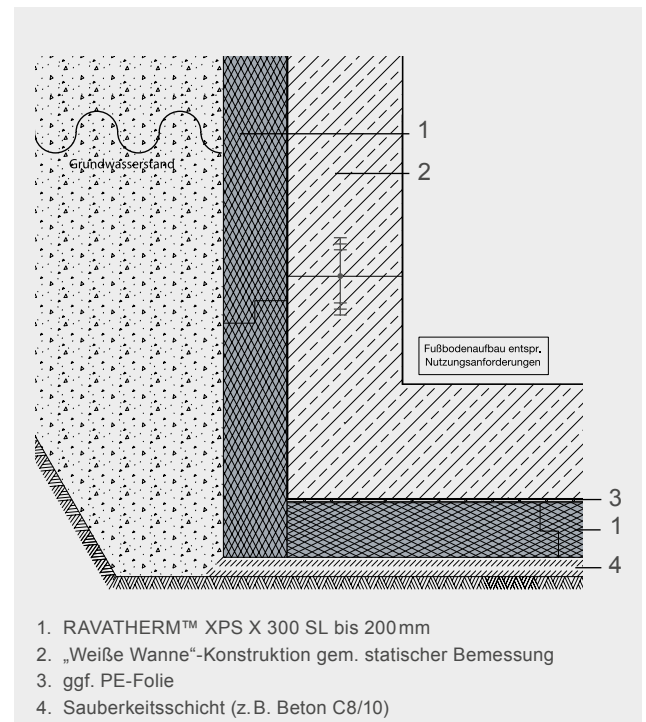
Detailbeispiel Fußpunkt „Weiße Wanne“: Wärmedämmung an Wand und unter lastabtragender Gründungsplatte in drückendem Wasser
